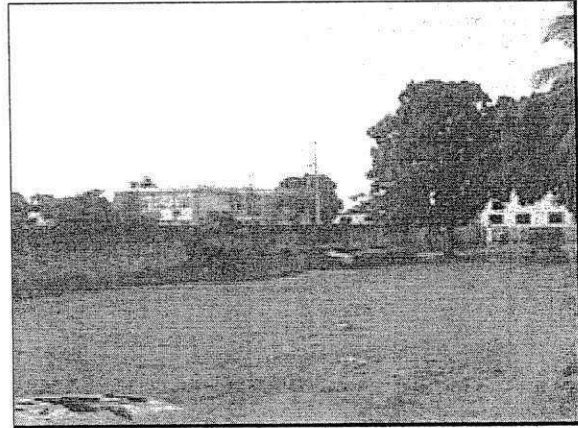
Vista do Terreno onde será construído o depósito de Cuité
